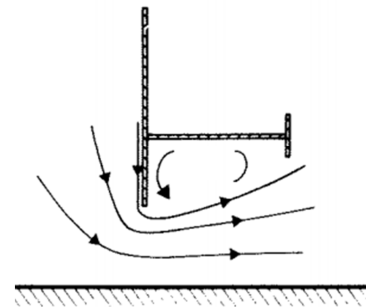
(c) – Seção inferior com reforço situado em posição baixa, gerando vibrações. (Kolkman, 1979)
